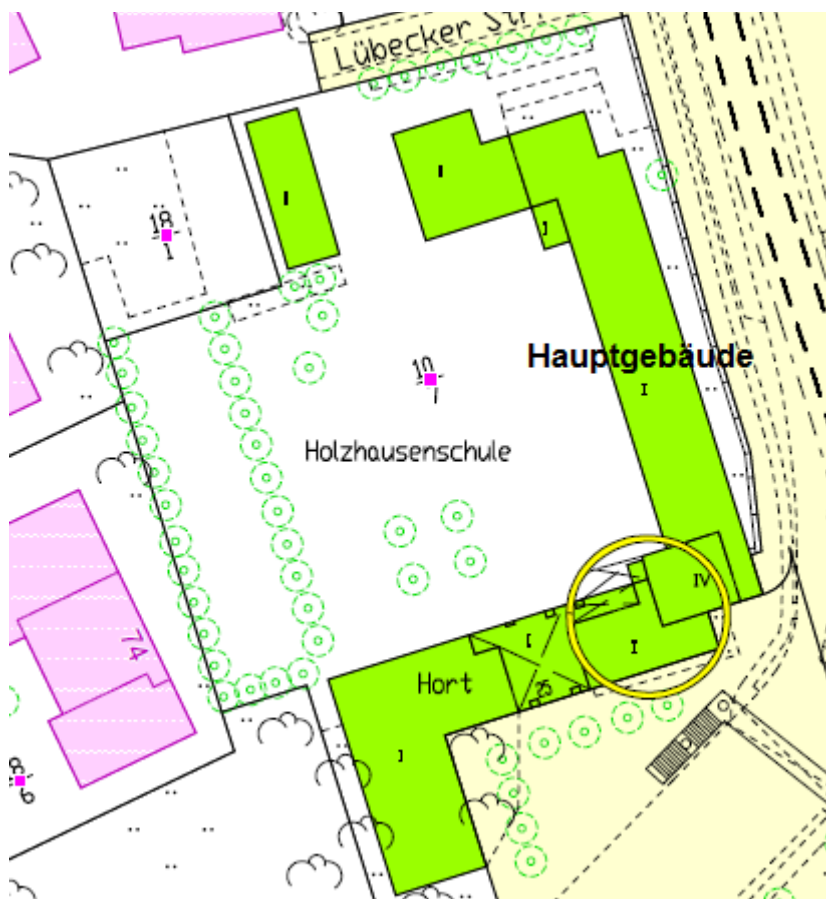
Lageplan Holzhausenschule mit Hauptgebäude
